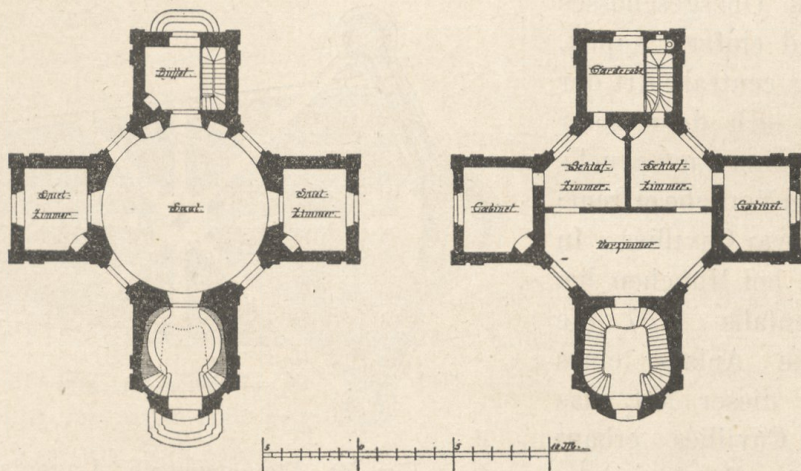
Clemenswerth, Grundriss des Mittelbaues.
